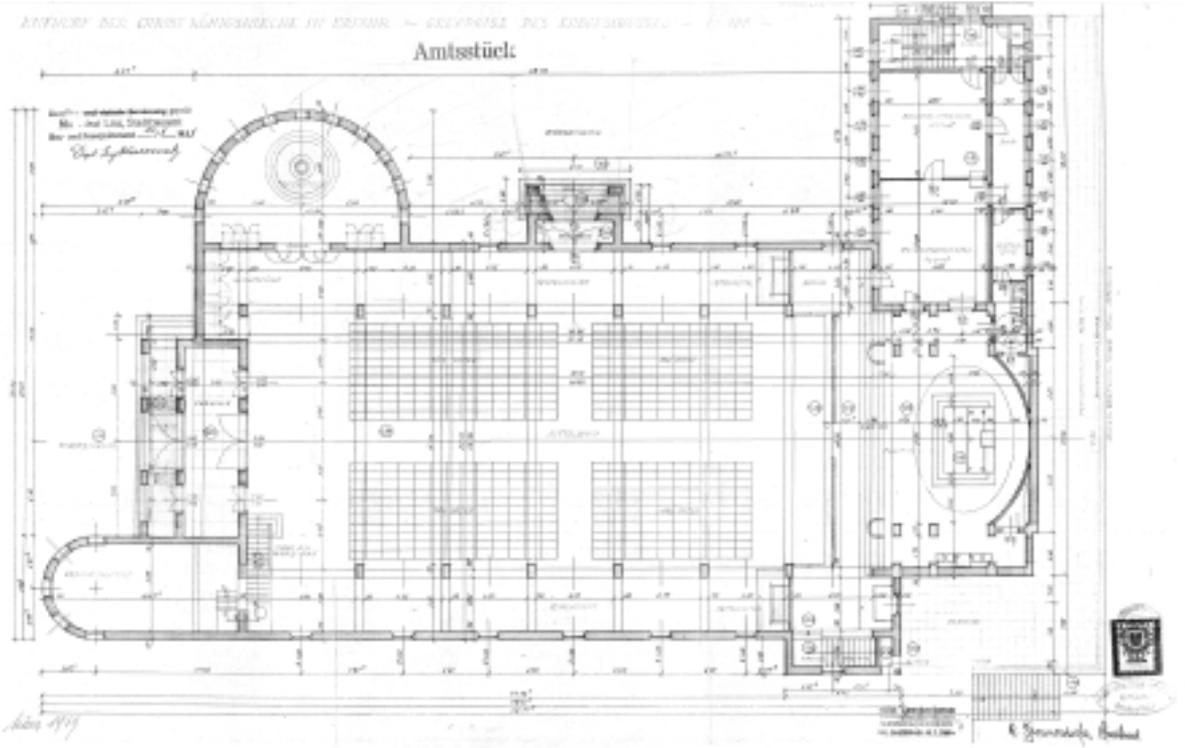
Vollendung der Kirche, Grundriss, von Hans Foschum, 1949
